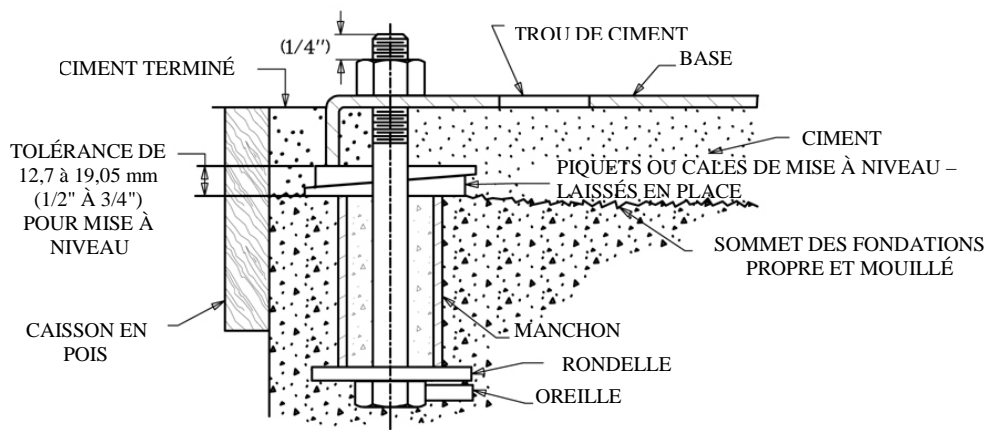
INSTALLATION TYPIQUE DE BOULON DE FONDATION
